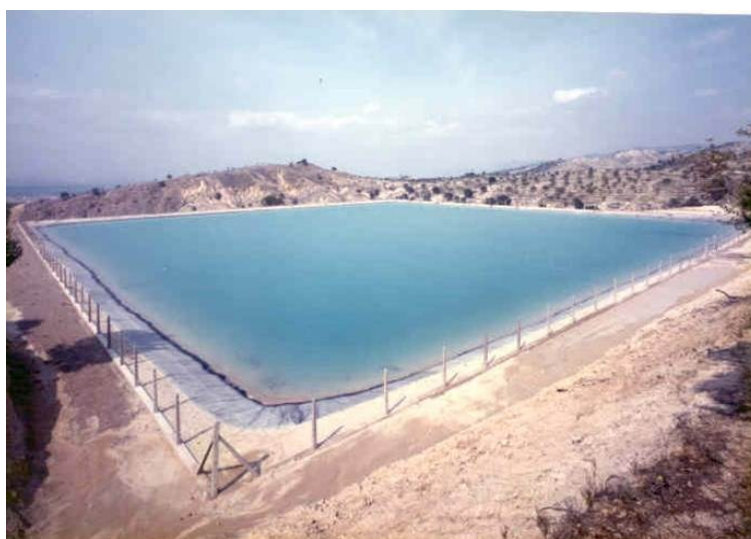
Zajištění nové fólie v rozích a u spojů dvou fólií samovulkanizující fólií
